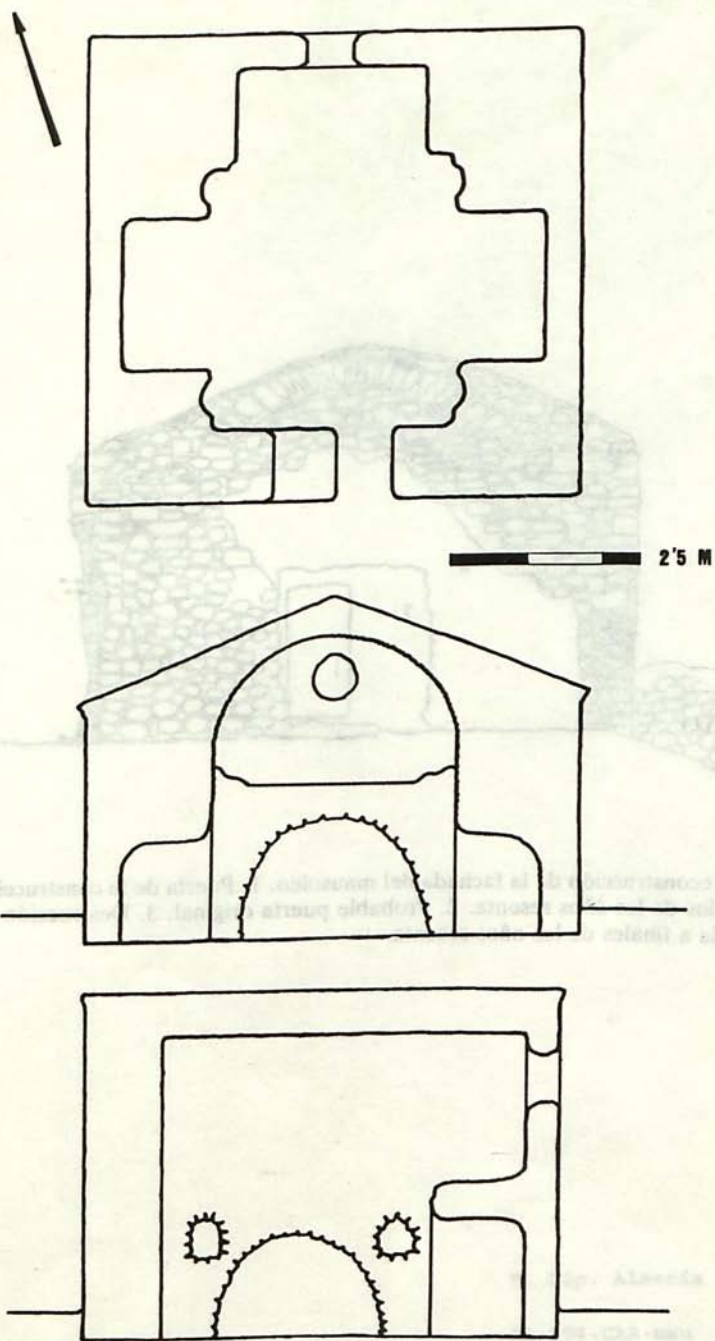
Planta y alzado de El Daymun (El Ejido).
